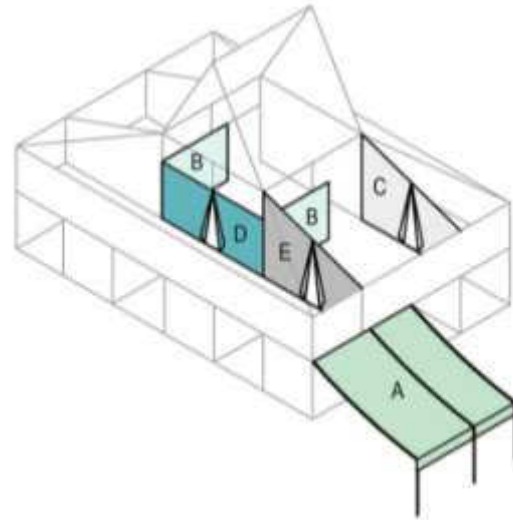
Utilizzo dei teli nella fase T.3-T.4
